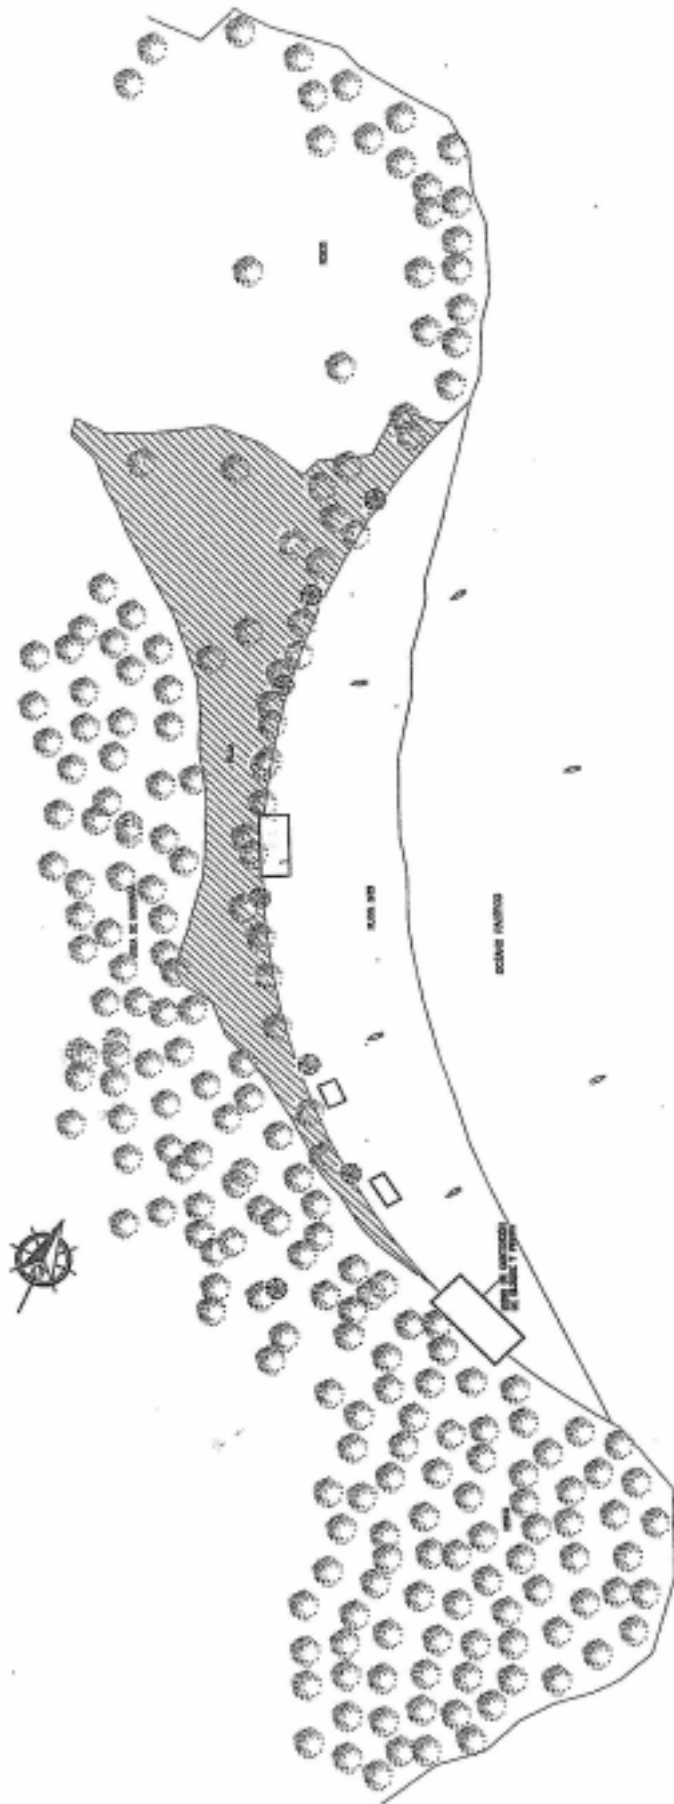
イスラ・コンチャグイタ漁村の概略平面図
